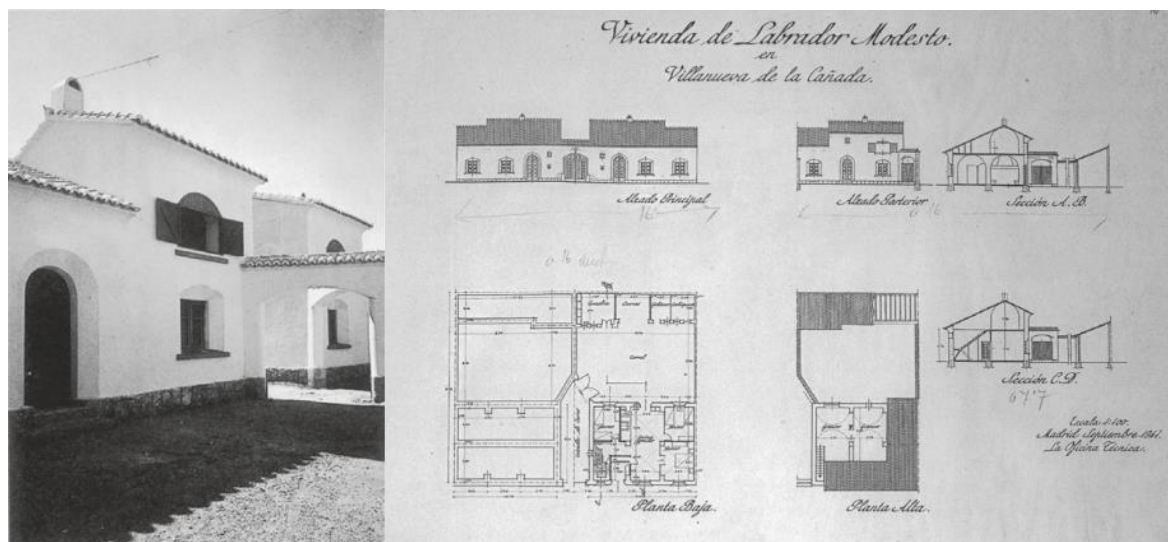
Vista desde patio y proyecto de vivienda labrador modesto. 1941. Fuente: Archivo General de la Administración.
